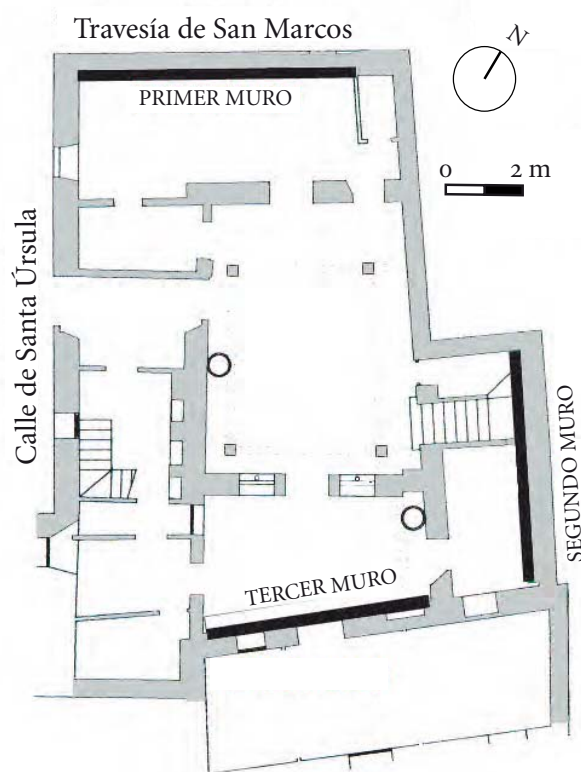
Casa de la calle de Santa Úrsula 11. Planta baja.
